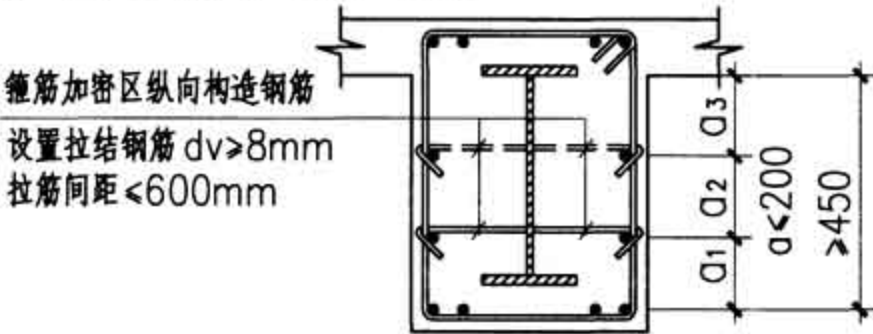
型钢混凝土梁纵向构造钢筋构造要求
